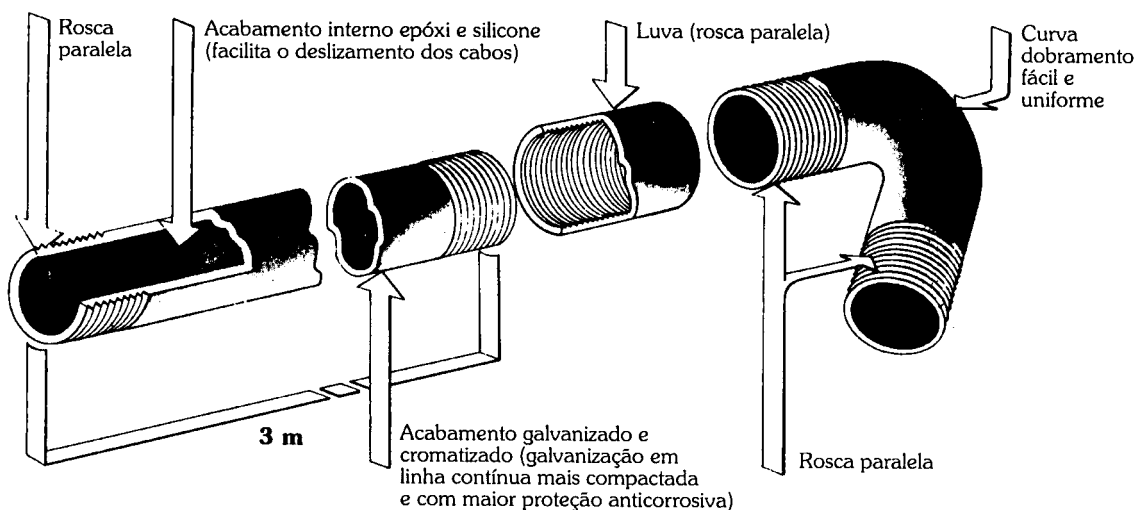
Eletroduto metálico rígido galvanizado, do tipo leve e pesado. Cortesia Eluma S/A - divisão Brundy.
